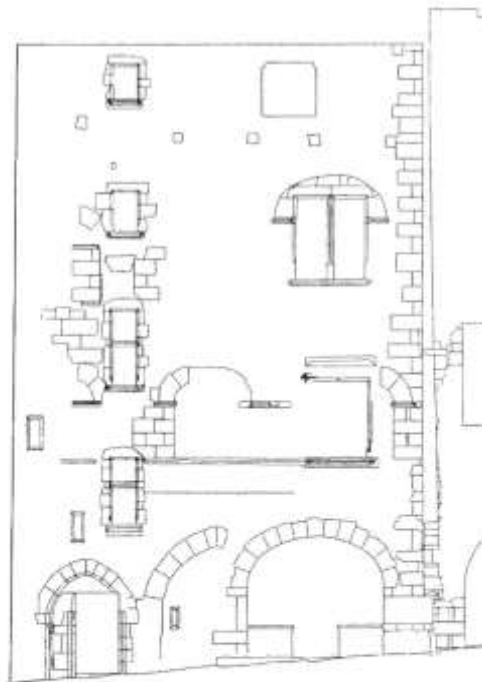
Caylus, maison 22, rue Droite (cad. 207), relevé photogrammétrique : la façade sur rue de cette demeure située sur la rive sud de la grande artère de la ville présente un mur goutteur (Inventaire général, extrait de *Caylus et Saint-Antoine-Noble-Val* 1993). Les étages sont très perturbés, mais les vestiges permettent de restituer l'ordonnance à cordon régissant et fenêtres géminées du premier étage et celle du dernier niveau, à baies simples couvertes de linteau sur coussines ; en revanche, au deuxième étage, les perturbations sont telles que la restitution est plus délicate et demanderait des sondages dans les murs.
